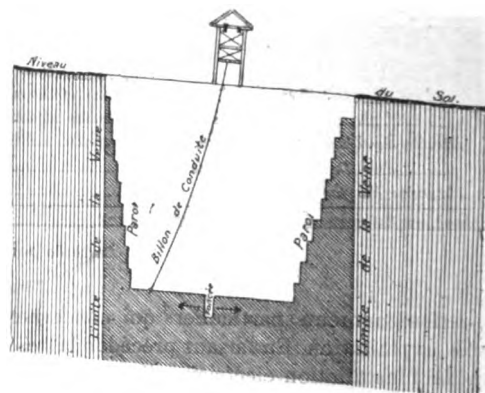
Coupe verticale d'un découvert normalement au fil de pierre.
